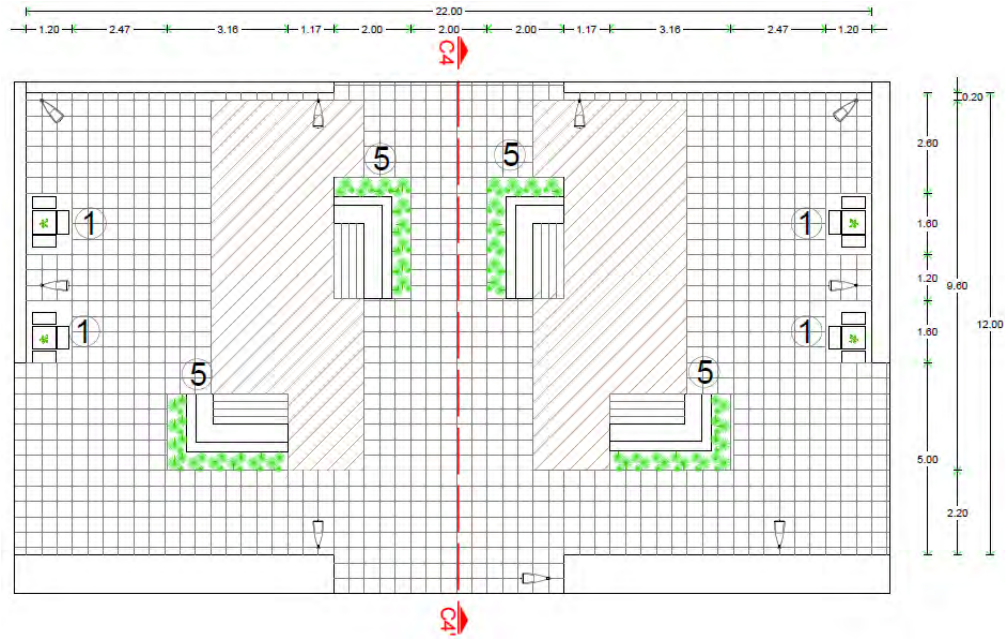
Planta arquitectónica de la plaza 4. Se muestra la disposición del mobiliario utilizado, además de los cambios de pavimentos utilizados.
